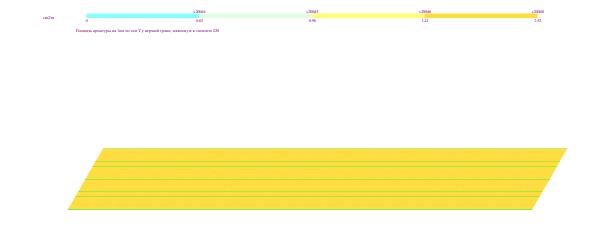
Требуемое армирование по верхней грани по оси У
